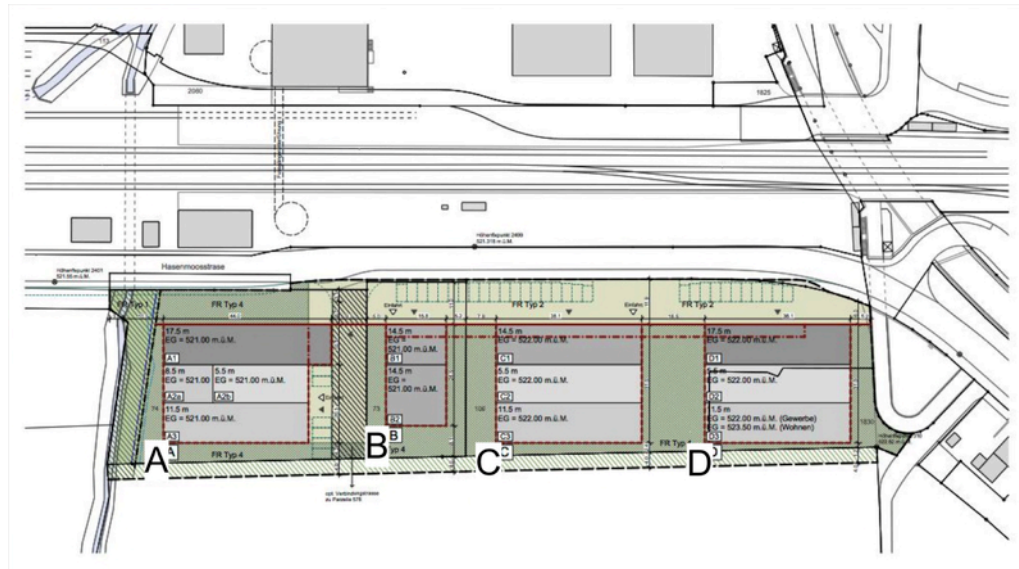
Übersicht Bebauungsplangebiet Rothenburg Station West mit den Baufeldern A bis D
